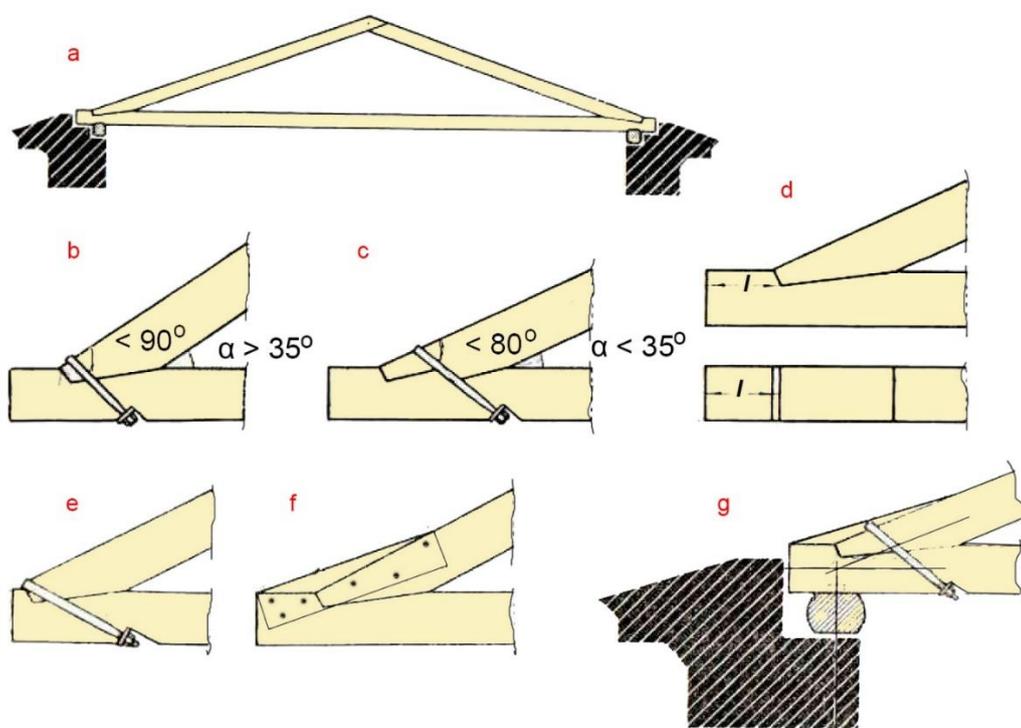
Висячие стропила двускатных крыш пролетом до 7.5 м: а – общий вид стропильной фермы; б – врубка стропильной ноги в затяжку простым зубом; с – врубка стропильной ноги в затяжку двойным зубом; d – организация врубки стропильной ноги с расчетным параметром свободного конца затяжки l ; e – врубка стропильной ноги с малым свободным концом затяжки при установке «узды» расчетной геометрии; f – введение кобылки с целью исключения перелома кровли нижнего участка ската; g – опирание затяжки на мауэрлат с выполнением правил пересечения осей элементов в одной точке [33]
